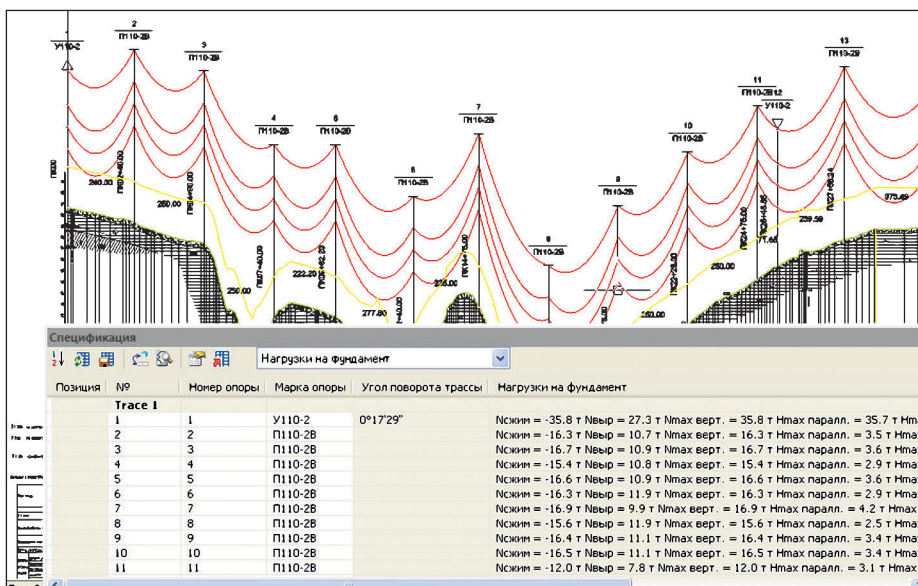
Результаты расчета нагрузок на фундамент в онлайн-режиме
